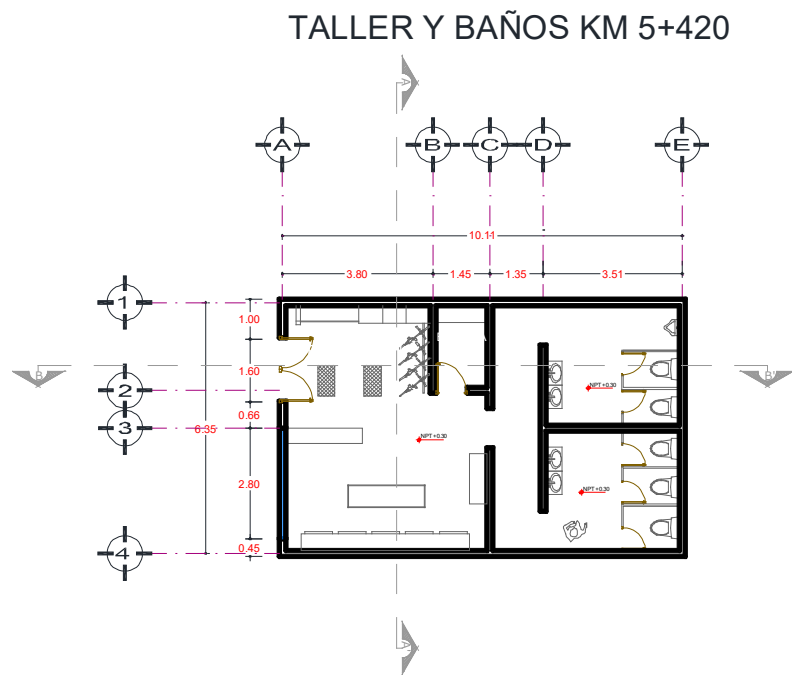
Propuesta Taller, Planta arquitectónica (Anexos Plano: 9-CORT-TALLER-01)
